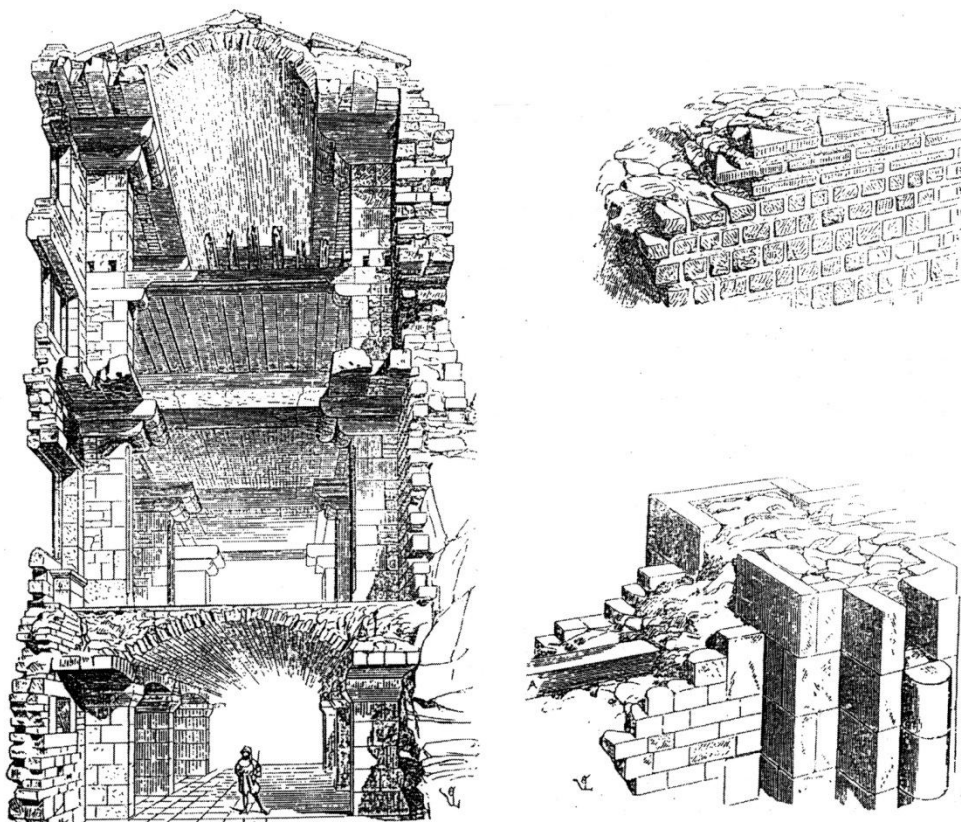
Sección constructiva de un edificio medieval. Detalles de la construcción de muros romanos y medievales. La estructura interna se aprecia con claridad con rellenos de cascote con manifiesta irregularidad. (Viollet-le-Duc, 1854)<sup>38</sup>
